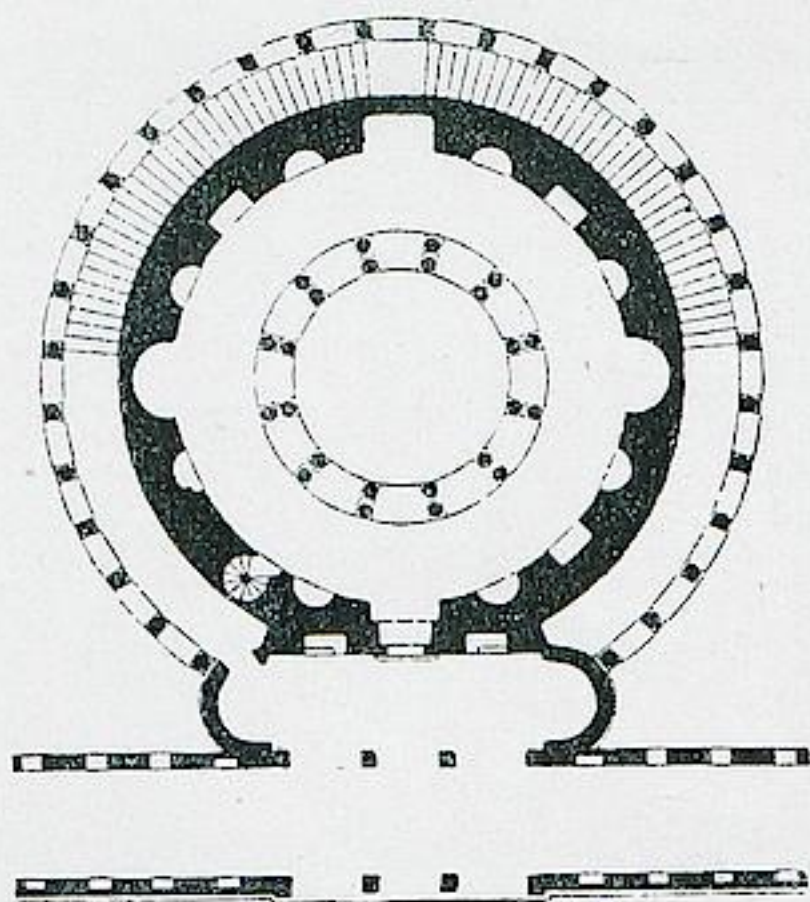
Roma. Pianta del mausoleo detto di Santa Costanza
